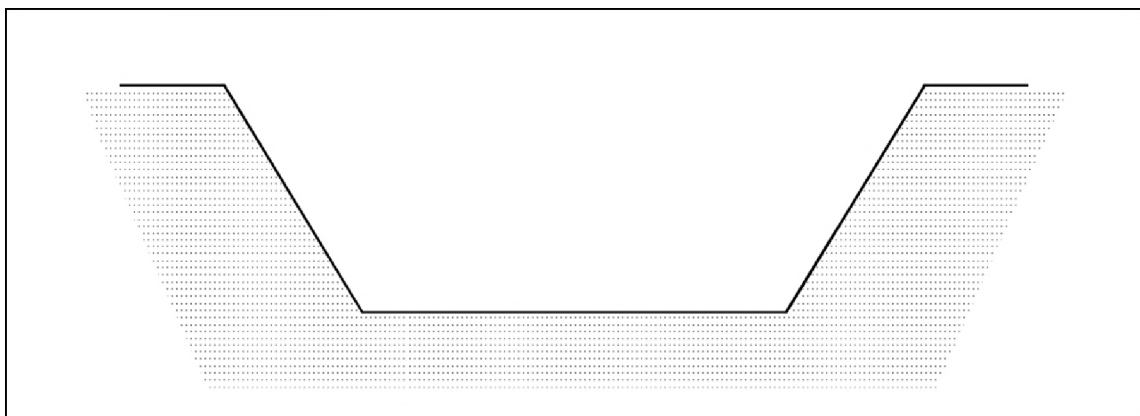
Coupe transversale d'un canal enterré de section trapézoïdale
